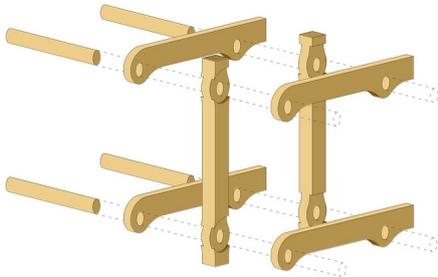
Esquema en 3D del ensamblaje de las piezas de la unión viga-pilar-viga.
